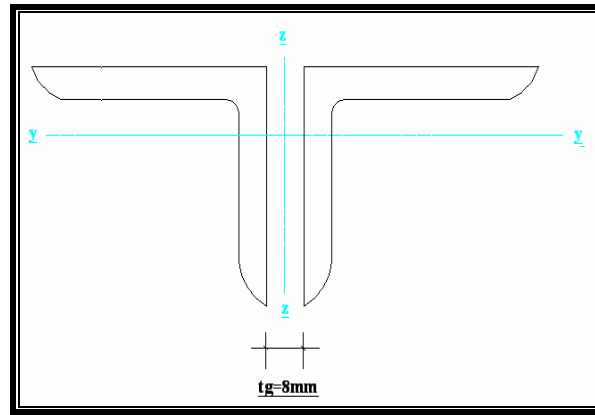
Schéma de montage de la barre 16-h.
